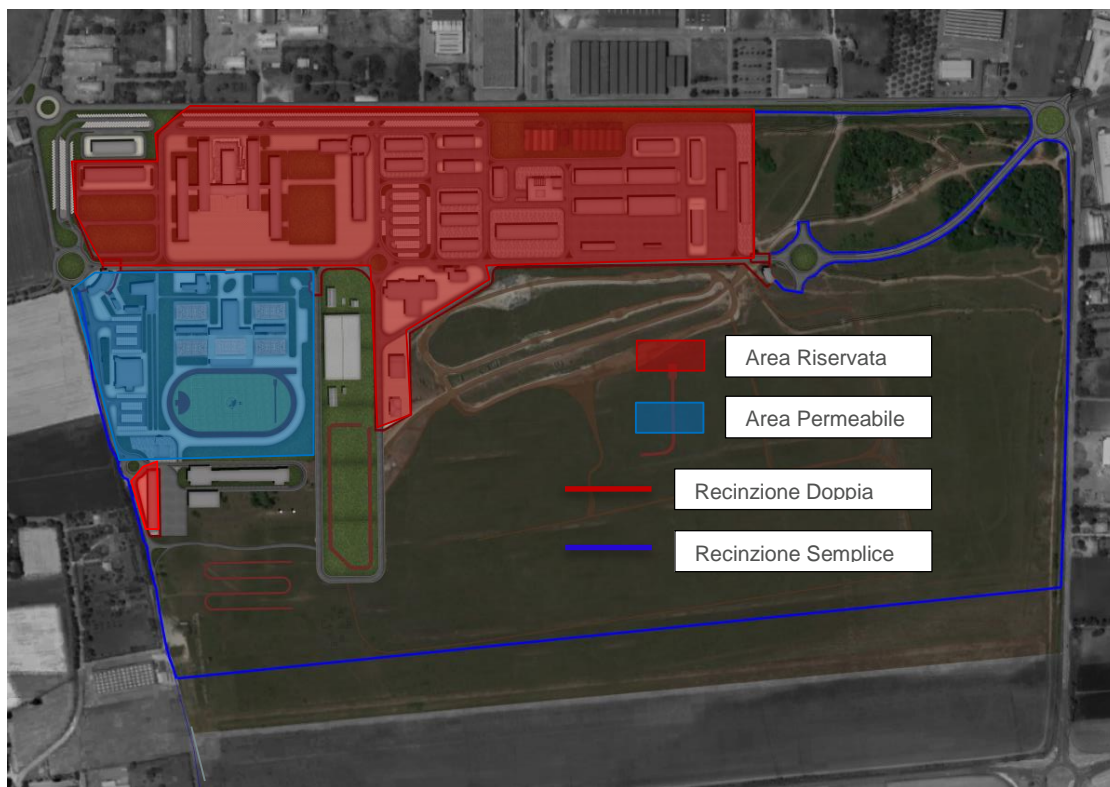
Planimetria Generale di Progetto. Schema Dual Use
